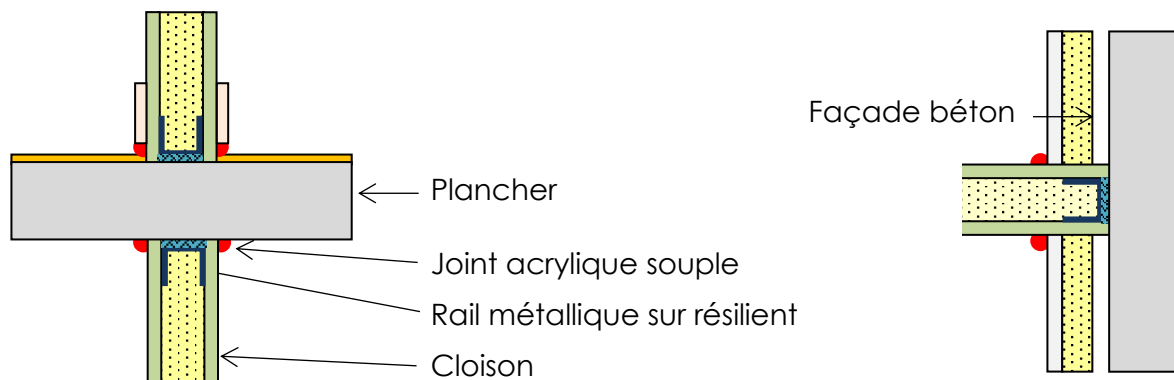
Jonction des cloisons légères avec les façades et les planchers (Coupe)/(Plan)
